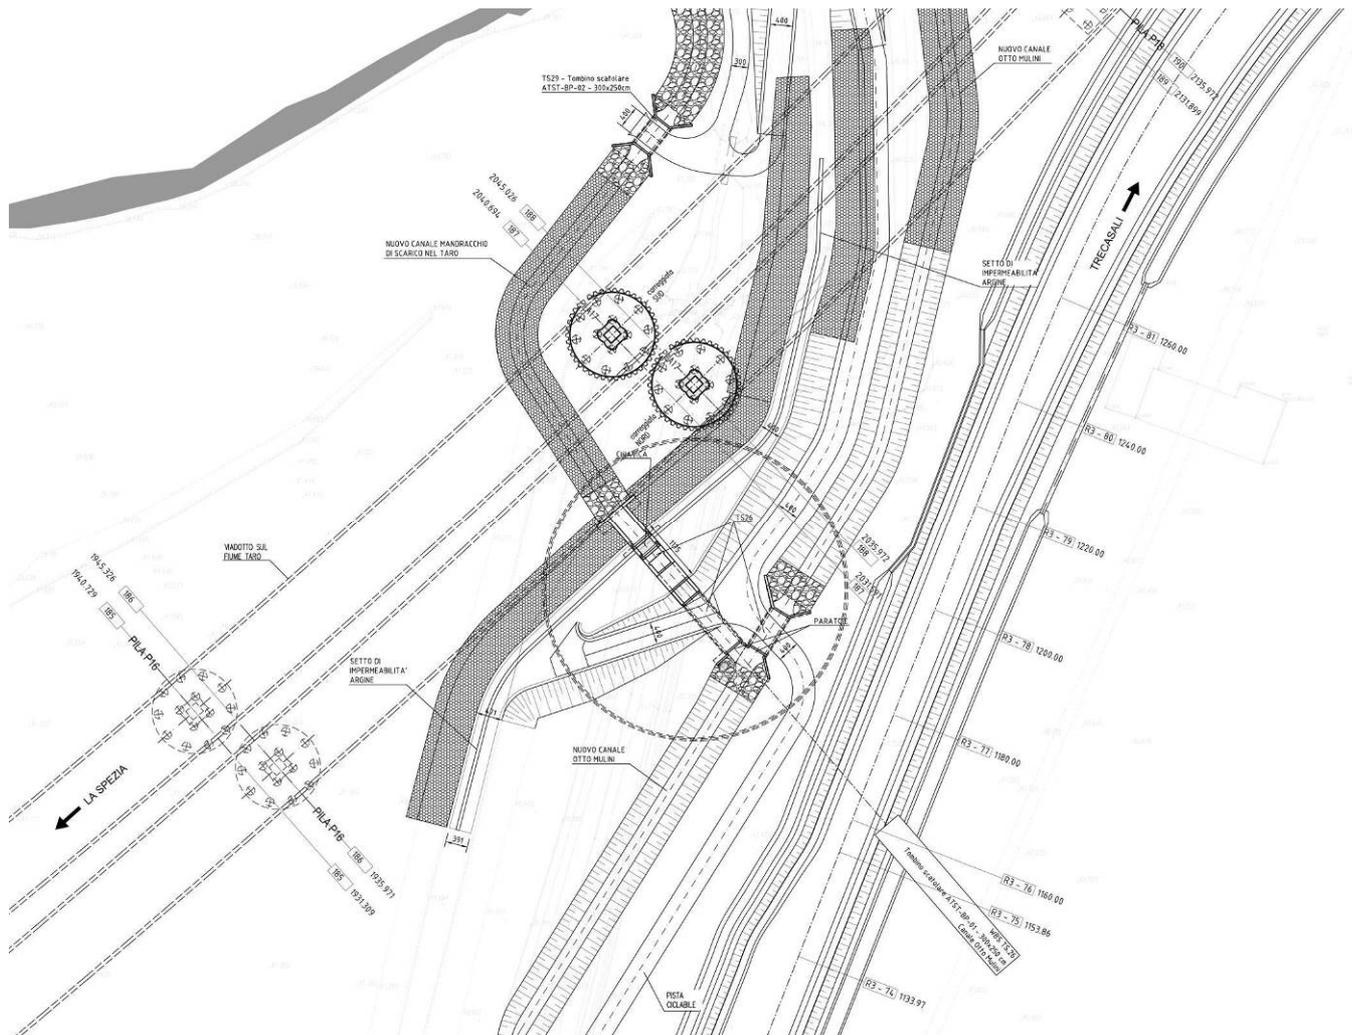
Stralcio della Tavola RAAA1EIAPTS26GPL001A - Tombino scartolare ATST – BP – 01 – 300x250 cm – CANALE OTTO MULINI – Planimetria generale individuazione dell'opera.
